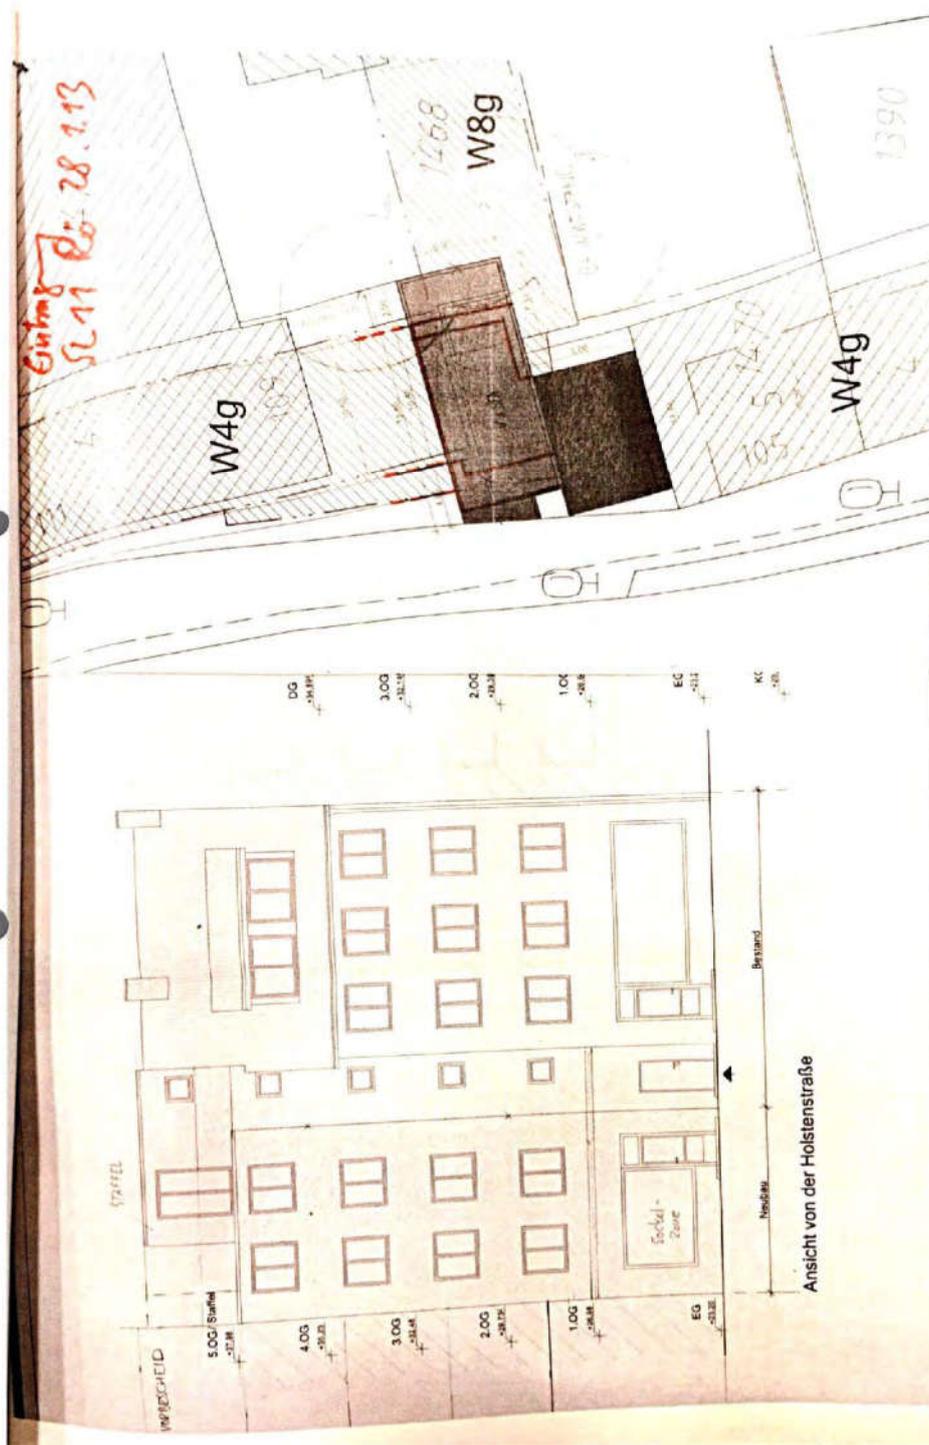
Bauvoranfrage (Antrag zurückgenommen)
